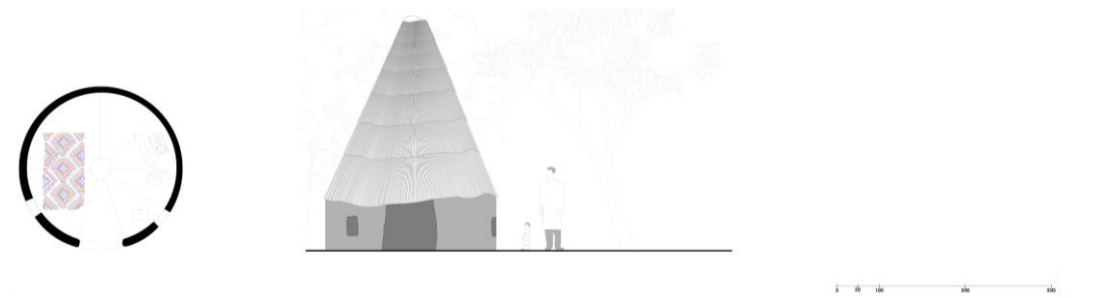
Grundriss und Schnitt, Rundes Haus (Quelle: Windisch, 2023)
